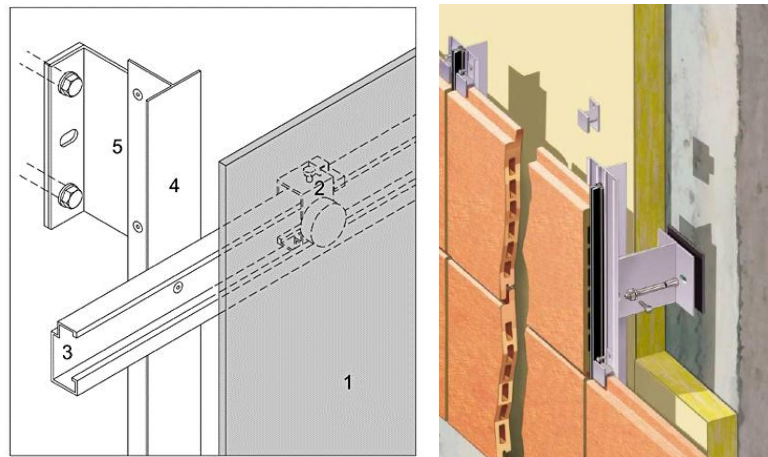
konventionelle Fassadenkonstruktion (Quelle: tectorum.de, winddimnet.de).
